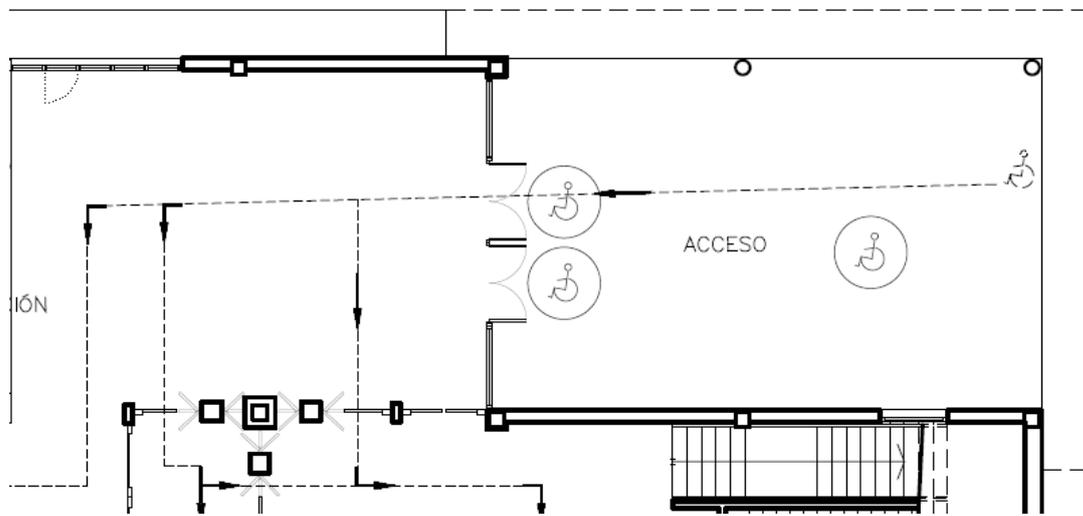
Planta Baja – Accesibilidad y Recorridos. Análisis del Acceso.
